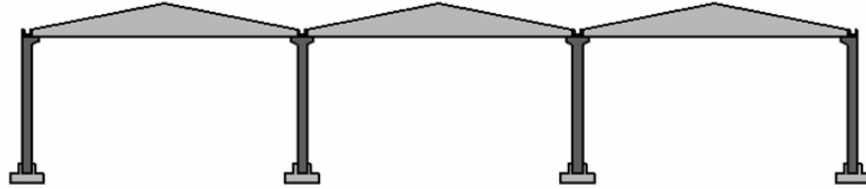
Prefabrik yapı elemanına ait detay
